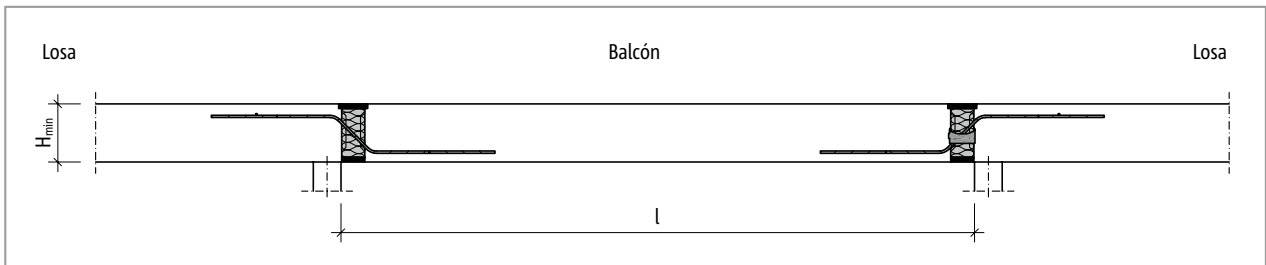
Schöck Isokorb® T tipo Q-Z, Q: Sistema estático (T tipo Q-Z-V6 hasta Q-Z-V12, Q-V6 hasta Q-V12)
